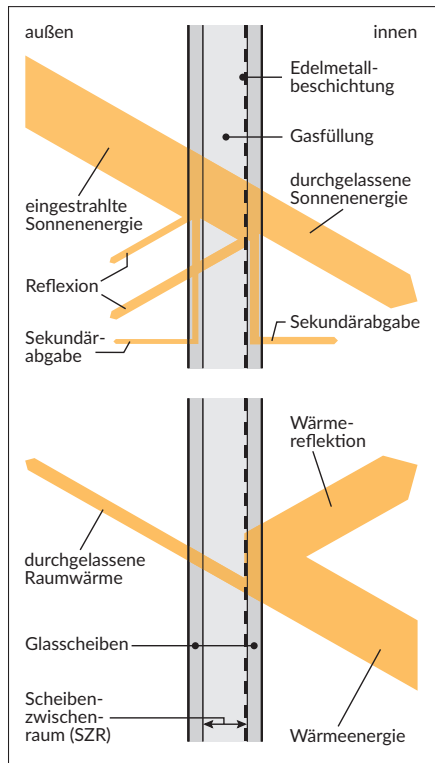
Wärmedurchgang durch ein Fenster mit Wärmeschutzglas (schematische Darstellung)
